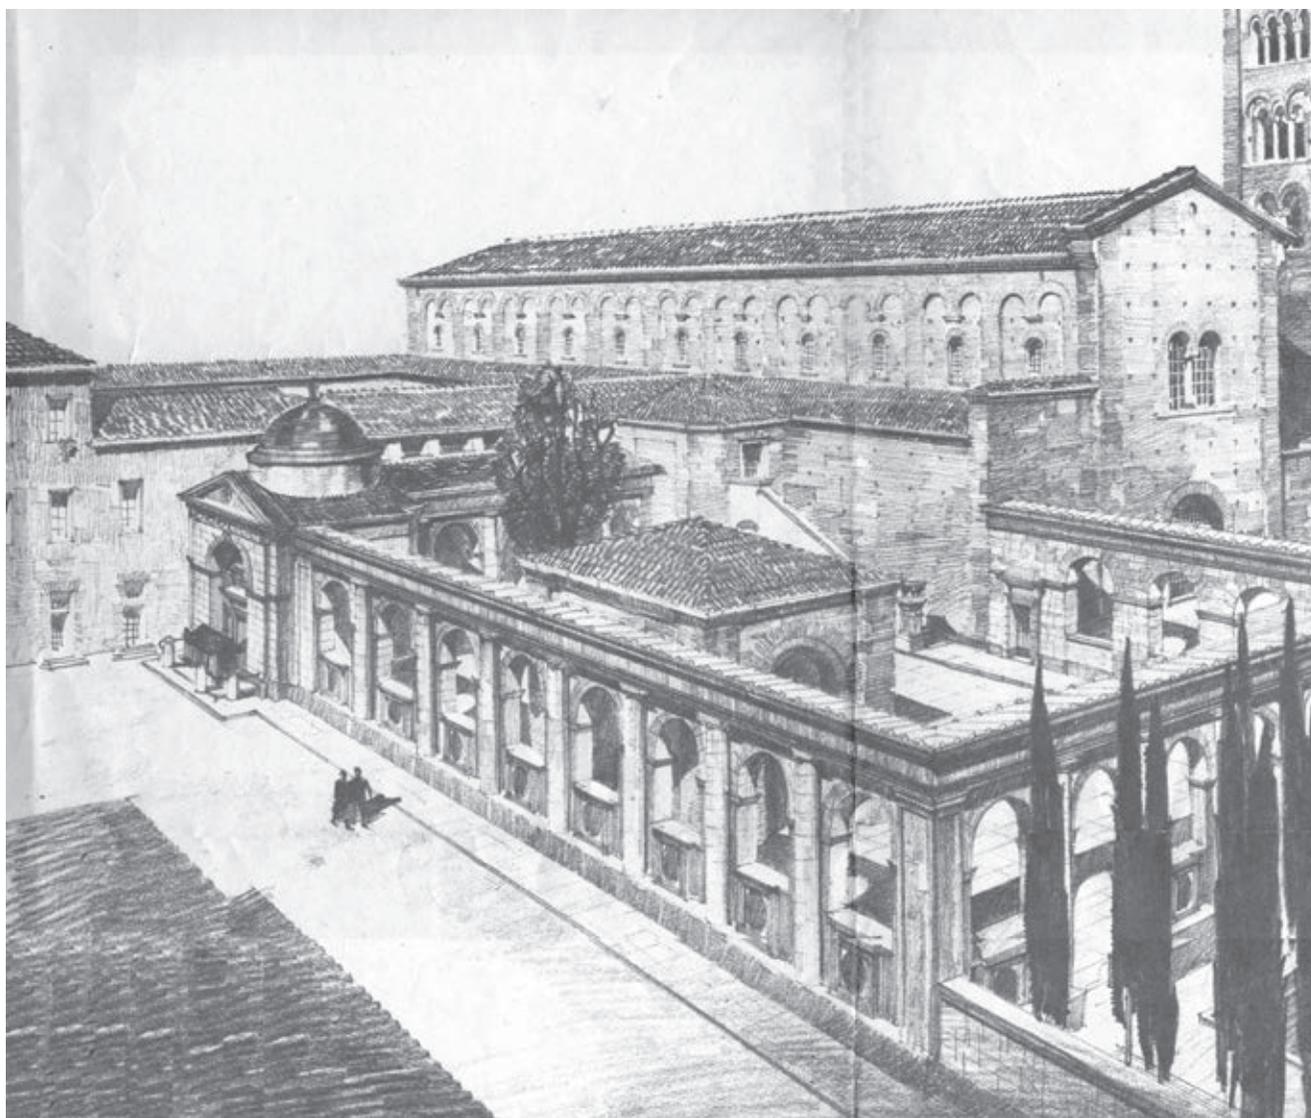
Gustavo Giovannoni, seconda versione del progetto per la zona dantesca di Ravenna, 1928. Prospettiva della soluzione con la conservazione del tempio settecentesco (Archivio privato, Ravenna).
